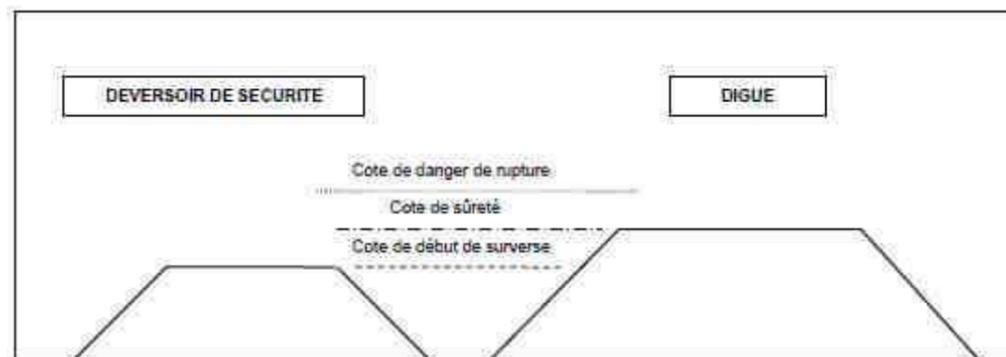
Rappel des niveaux de protection d'un ouvrage d'endiguement
